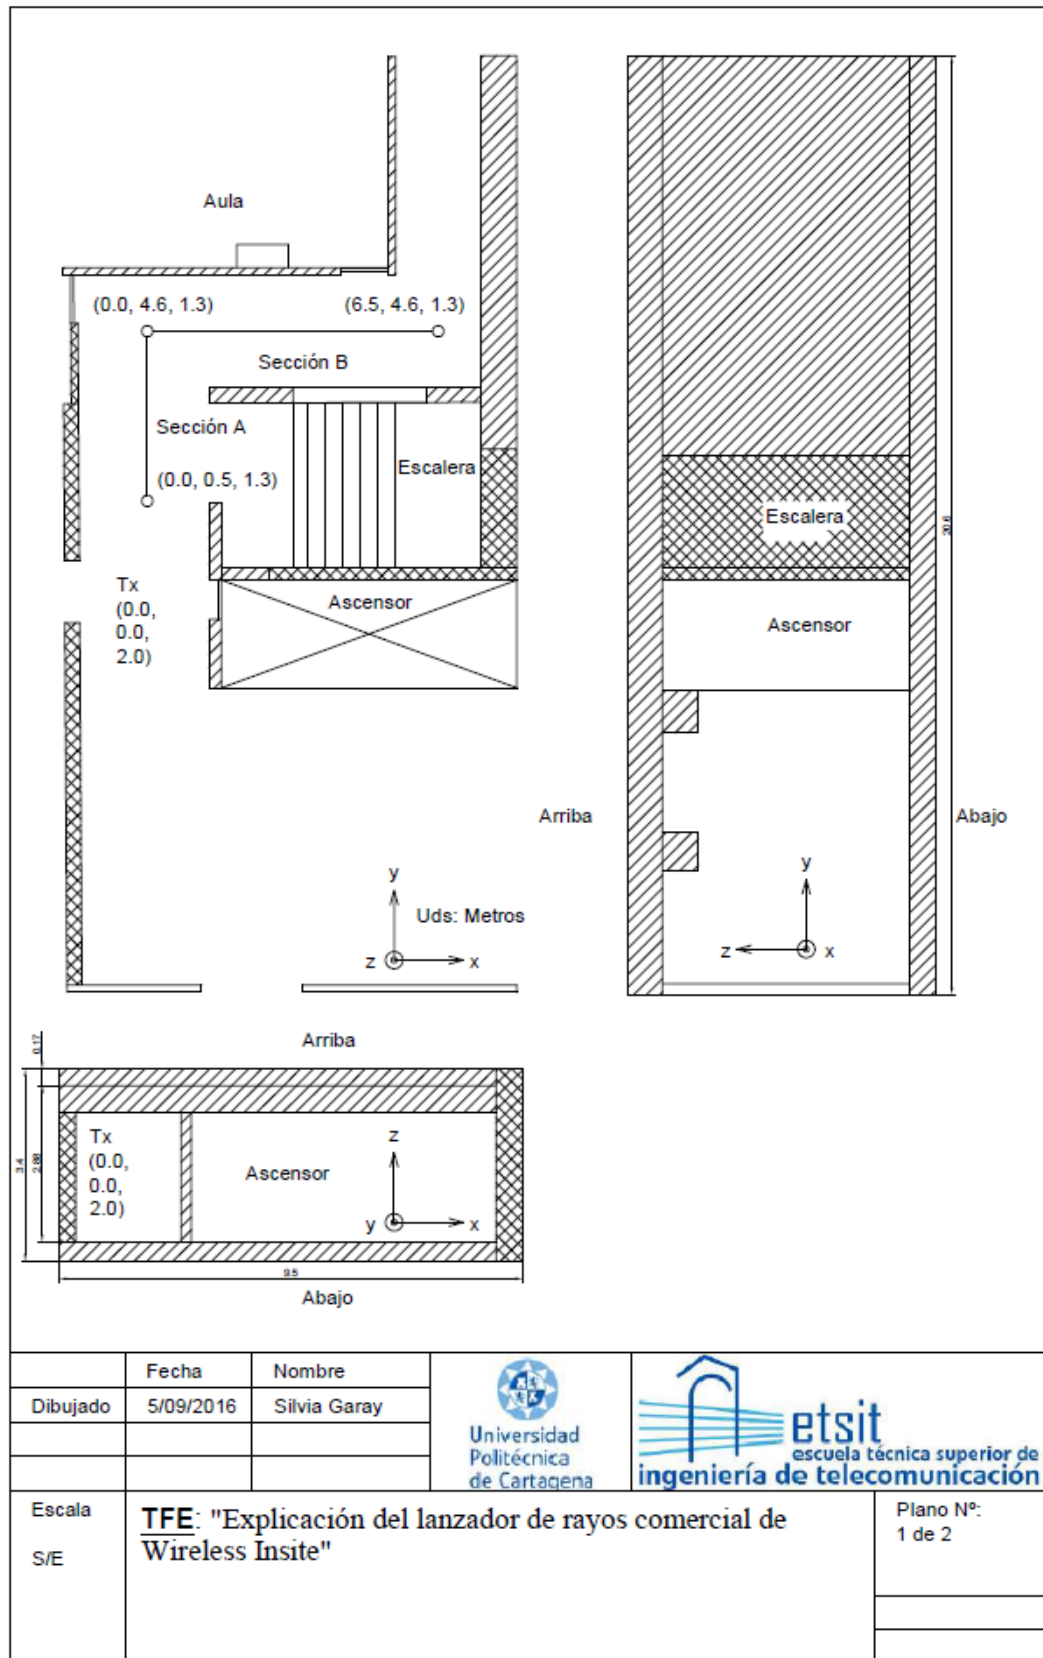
Plano en planta del ejemplo propuesto en el Tutorial
